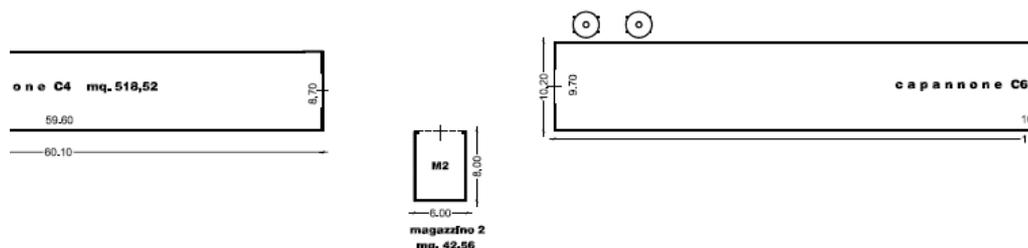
Pianta magazzino 2 (fonte: A. I. A.)
